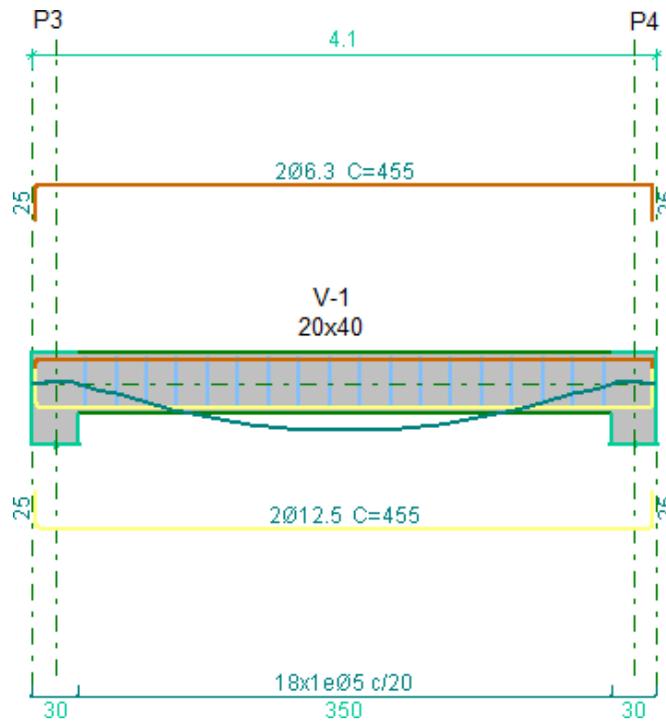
Detalhamento da viga em concreto armado da Opção 01 em corte longitudinal.
